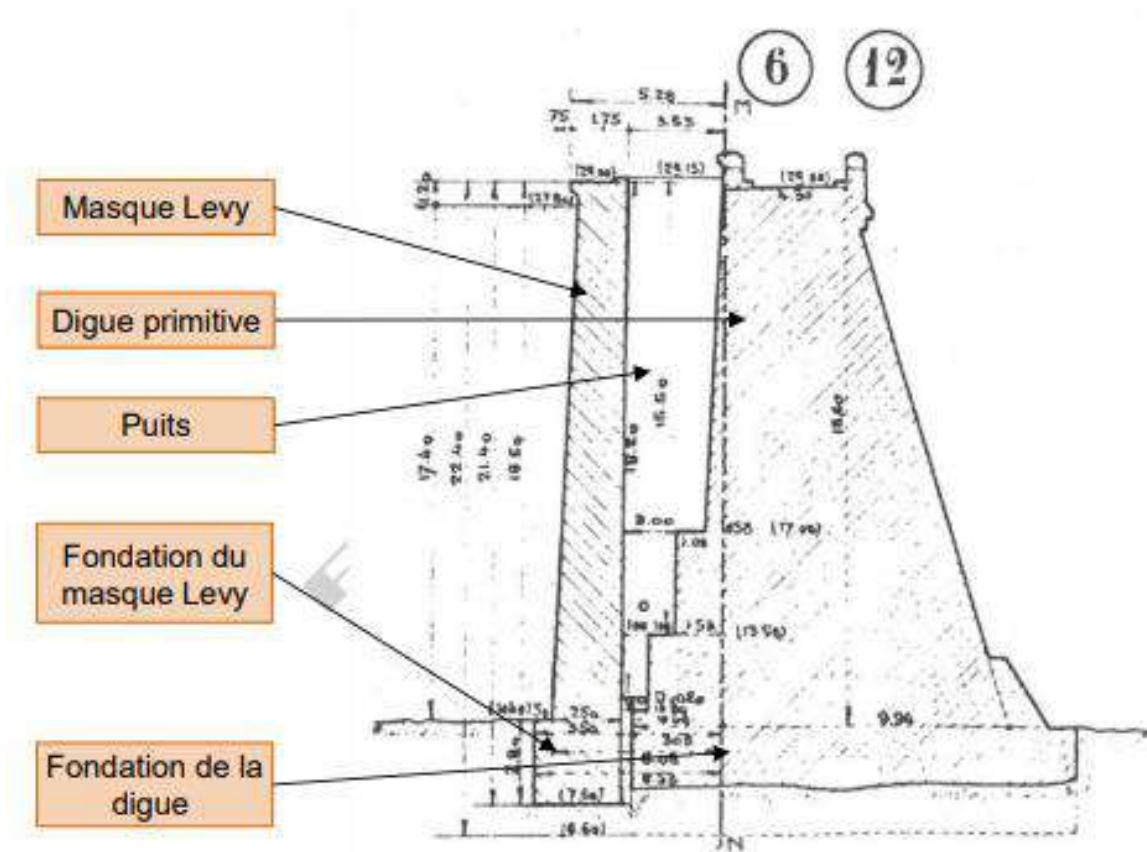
Coupe type du barrage avec masque Lévy au droit d'un puits prenant appui directement sur la digue primitive (source : EDD ISL)
